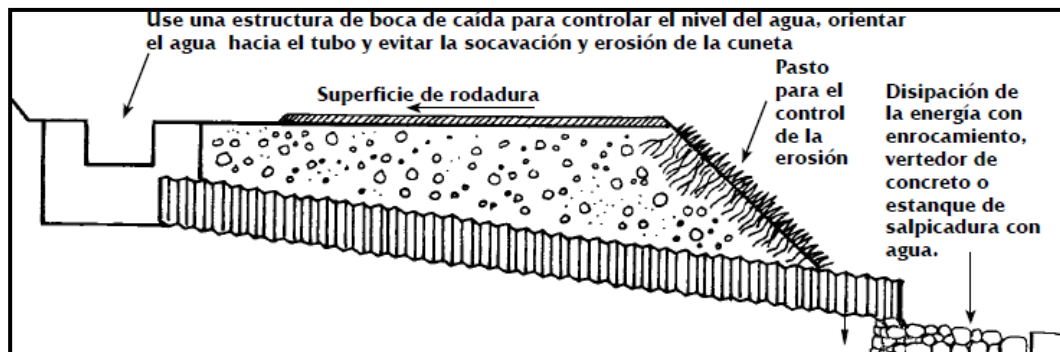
Tipo común de estructura de caída (sección transversal de una alcantarilla). Fuente: Ingeniería en caminos rurales (Keller y Sherar).
